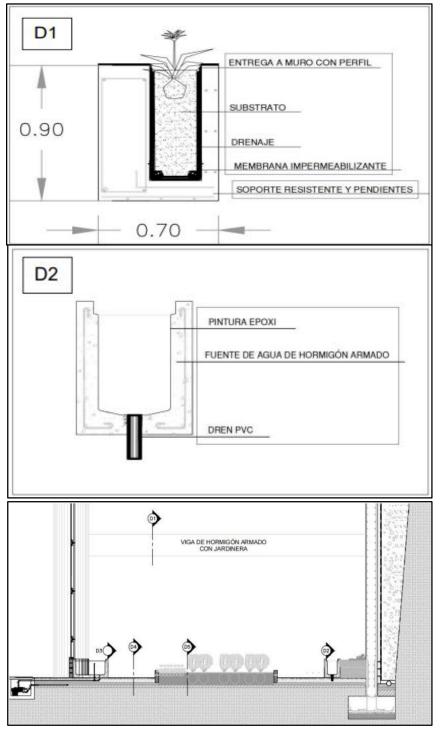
Detalles constructivos, sistema de recolección de agua y jardinera en viga
